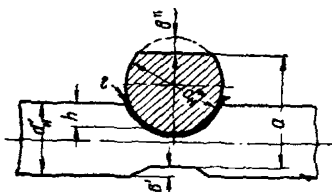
Схема сварного соединения двух пересекающихся стержней арматуры
